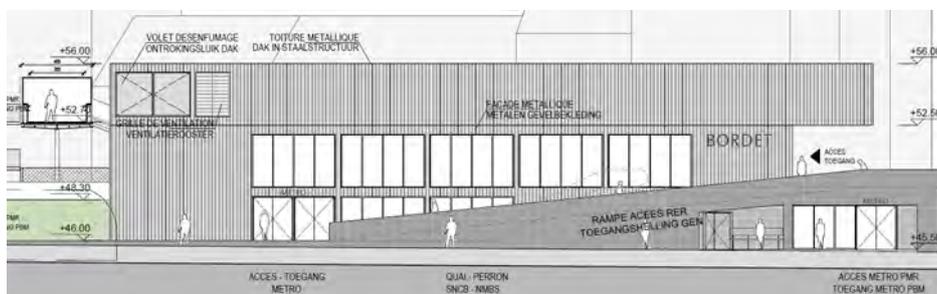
Plan de la façade sud du pavillon « Petit Bordet » (BMN, 2018)
